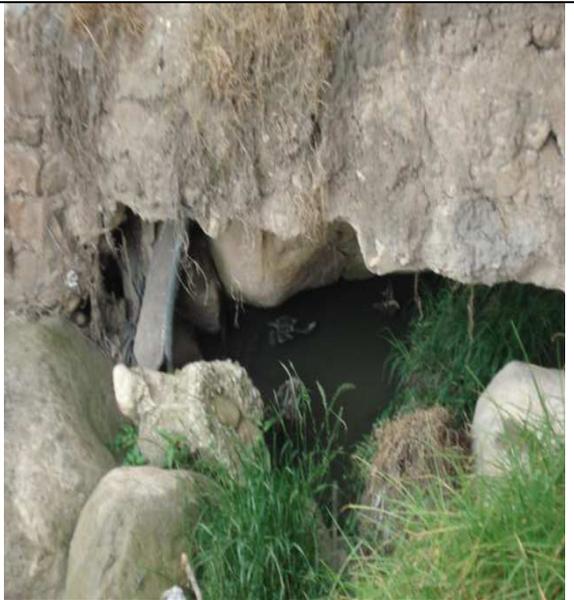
Socavamiento en una de las presas utilizadas para contener, las basuras y otros sólidos en la quebrada.
